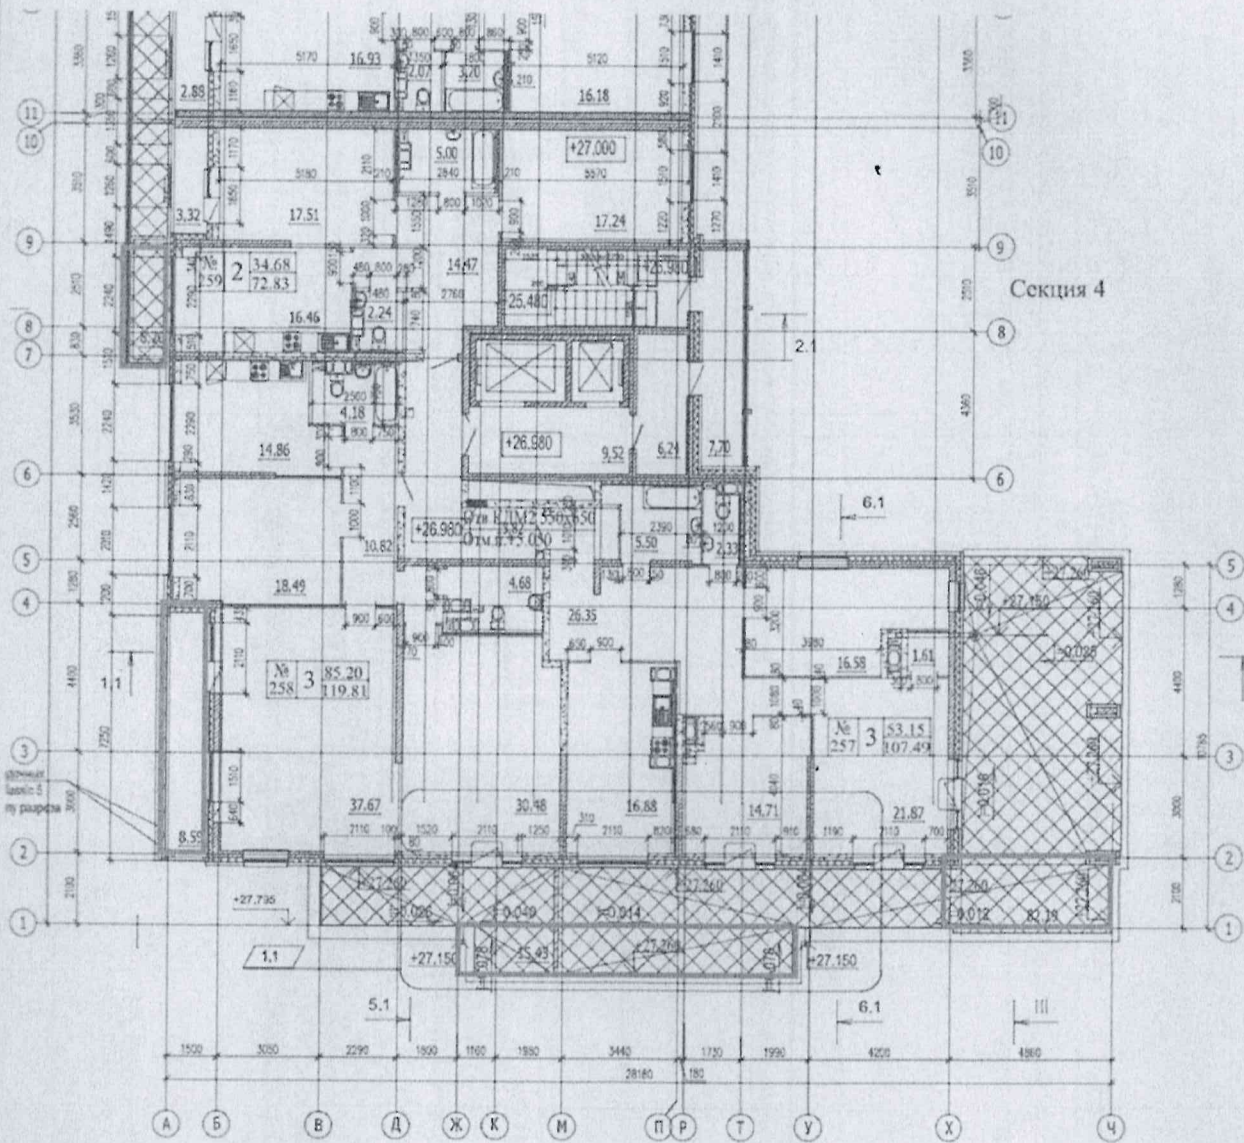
План девятого этажа. Консольные плиты над 9 этажом.
